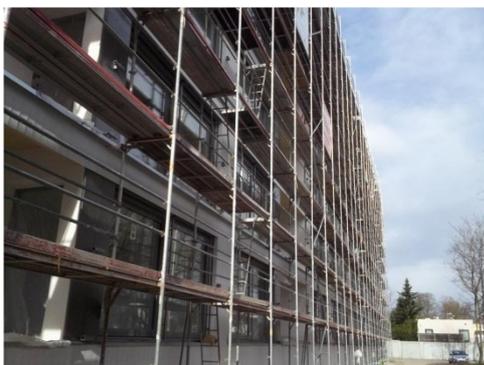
Execução em edifício em Augsburg (Alemanha) – montagem da fachada (fonte: Autor).
